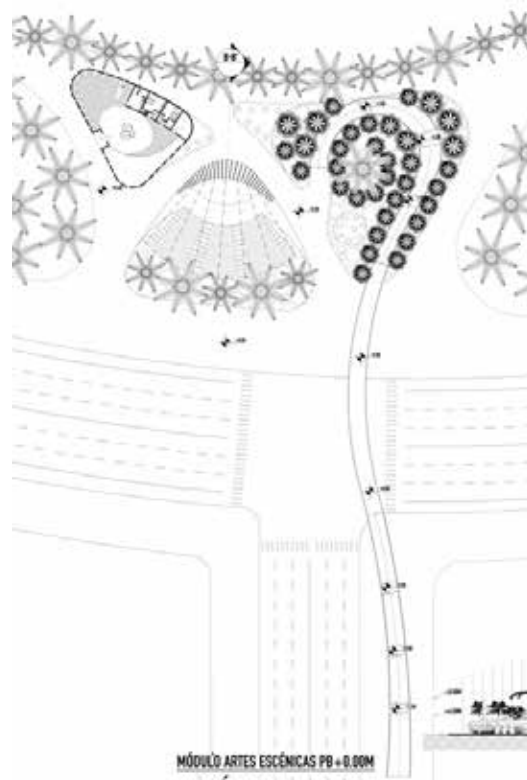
Módulo de Artes Escénicas Planta Baja Nivel +0.00. Fuente Propia. 2017.
